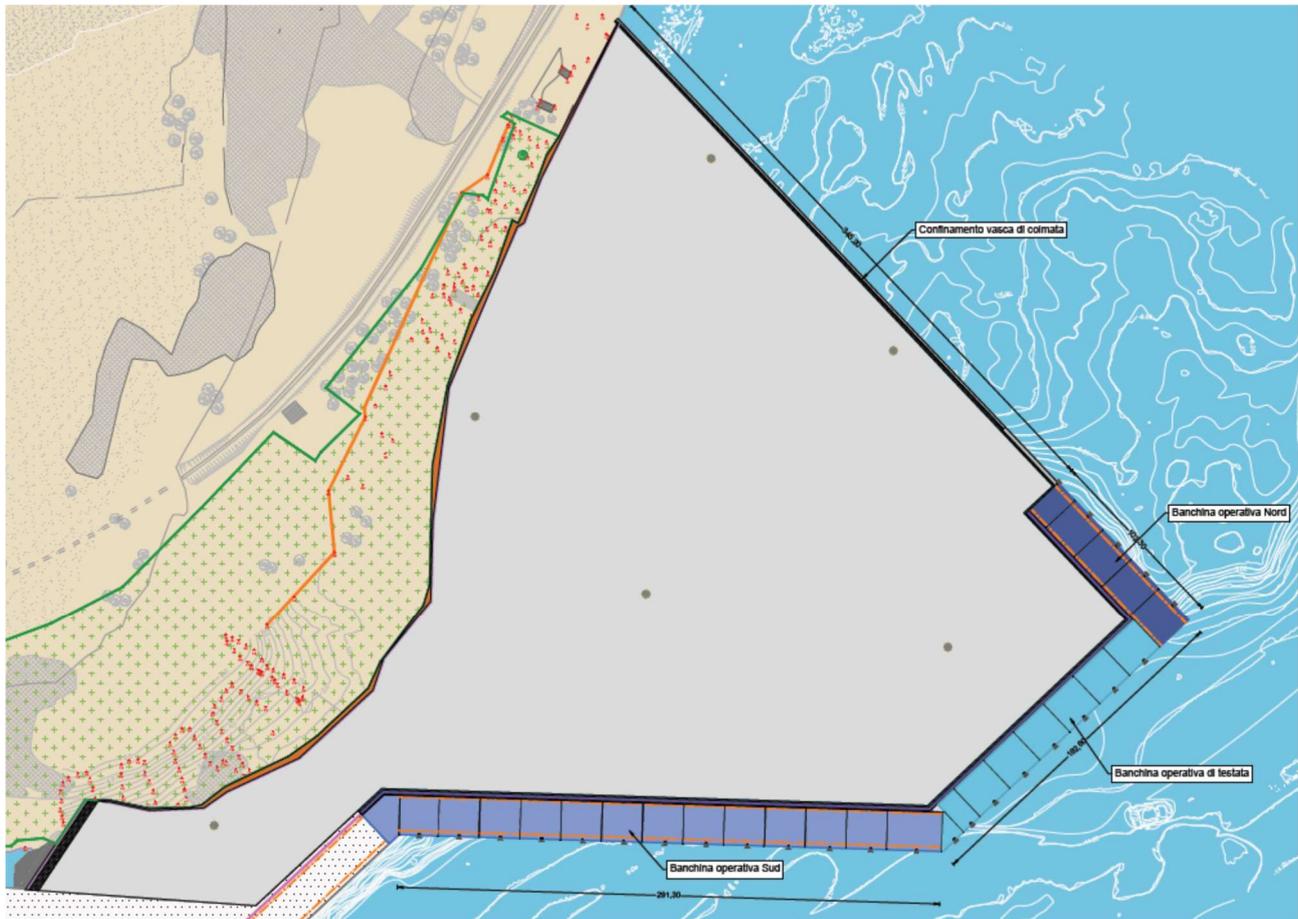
Progetto Esecutivo: Planimetria di progetto
